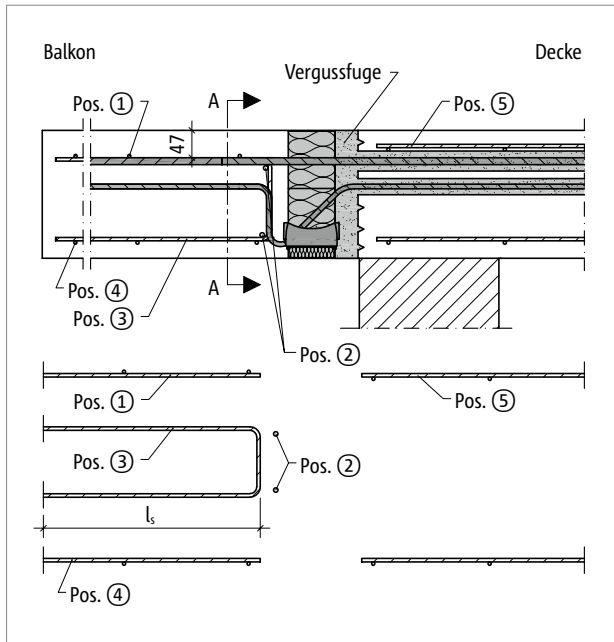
Schöck Isokorb® RT Typ K: Bauseitige Bewehrung bei direkter Lagerung
